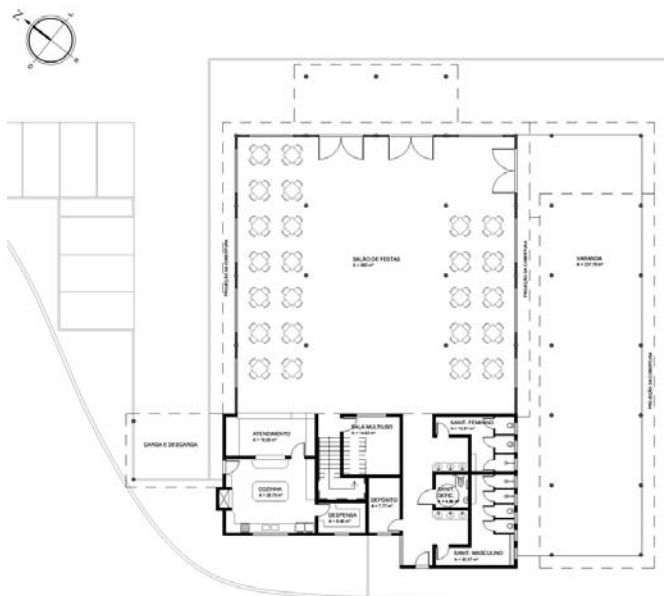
Planta baixa do pavimento térreo da Sede da Associação de Moradores.
